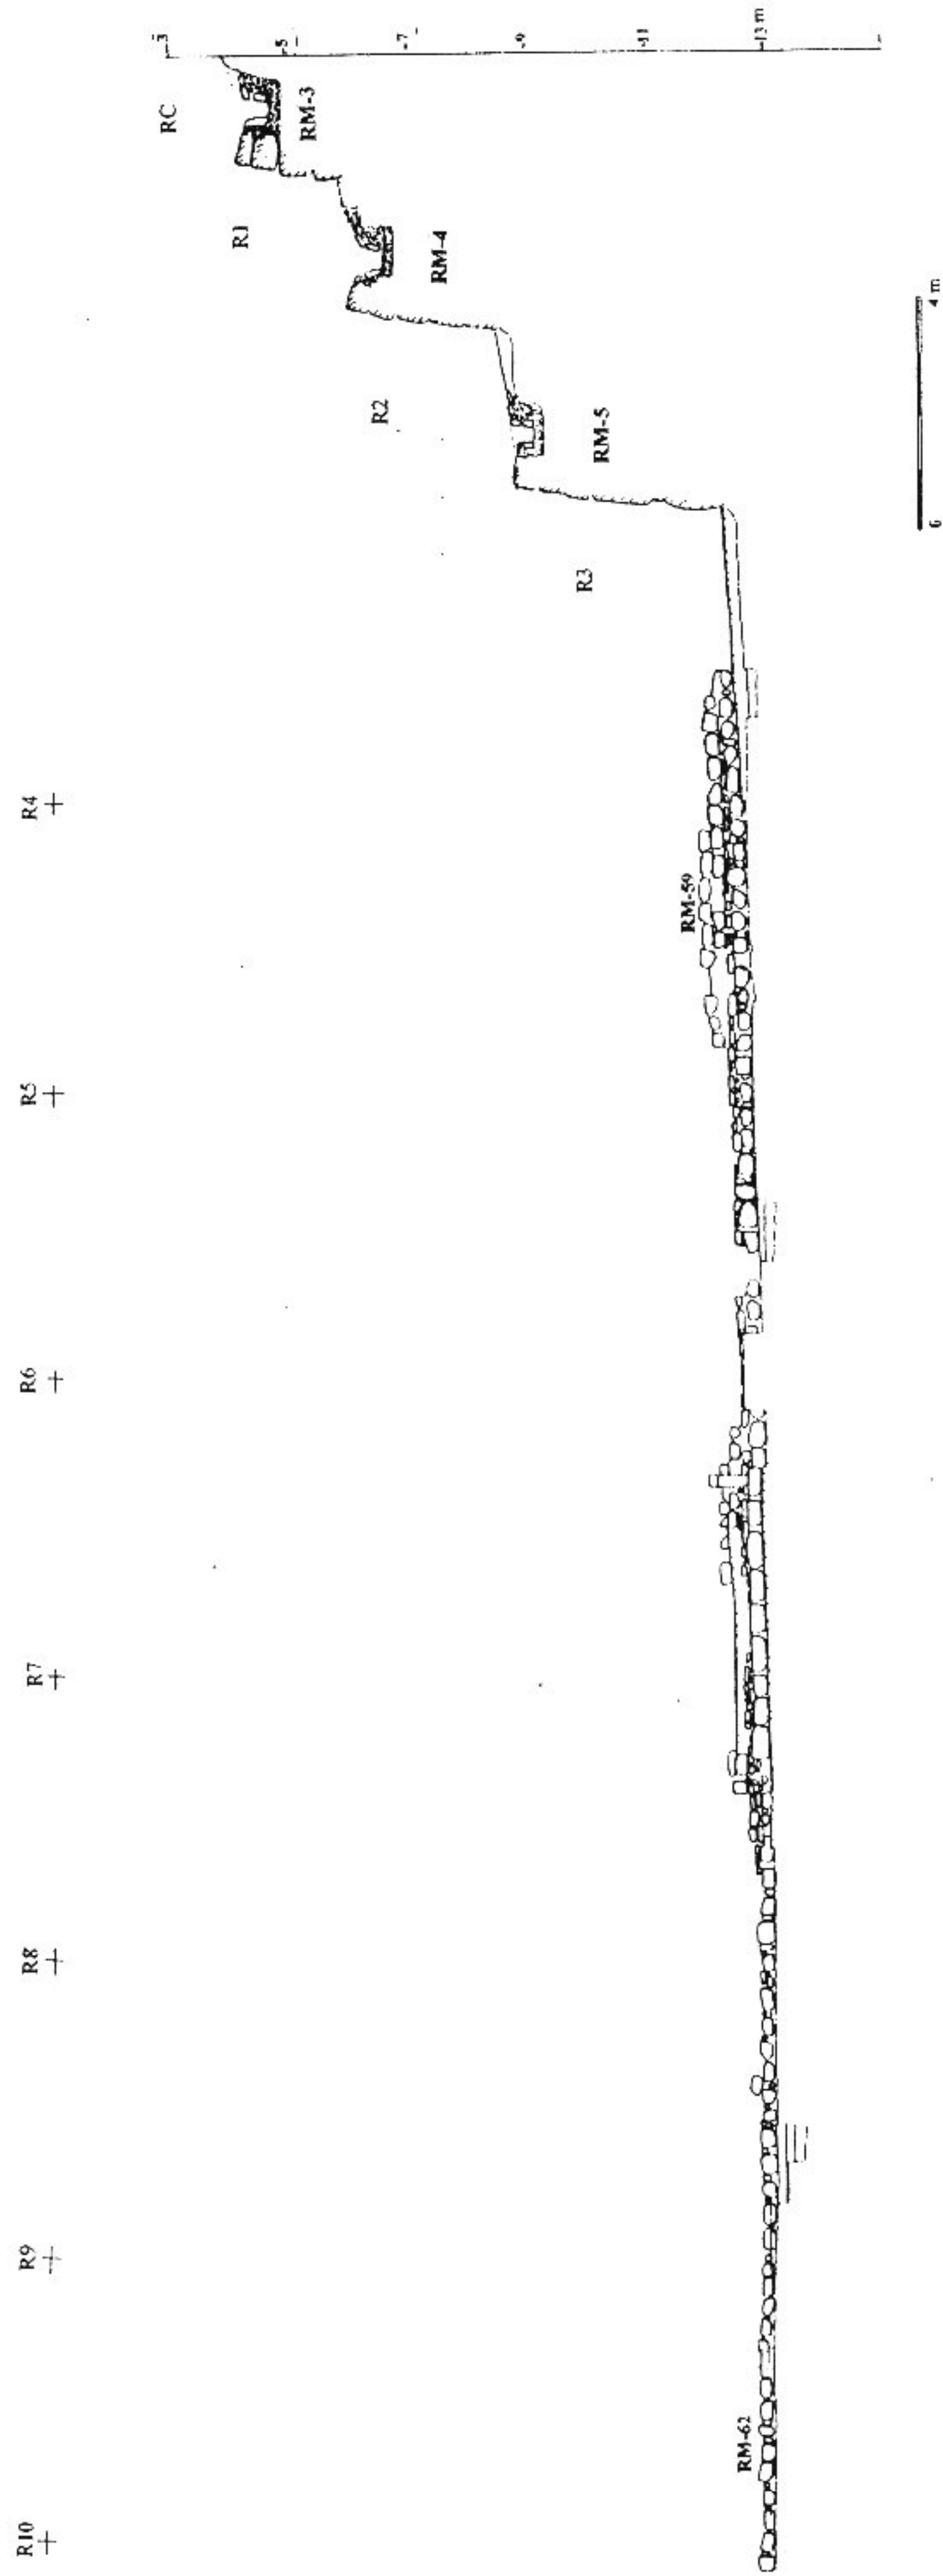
Perfil de muros RM 3-5 y fachada frontal oeste lado exterior Plaza Delantera
